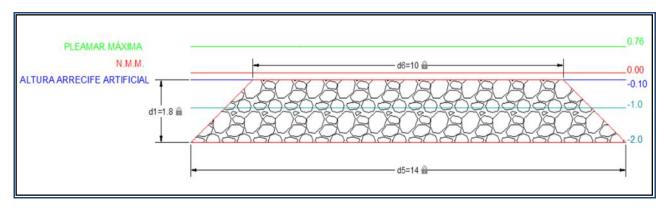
Corte transversal de la estructura del arrecife artificial que se pretende construir.
